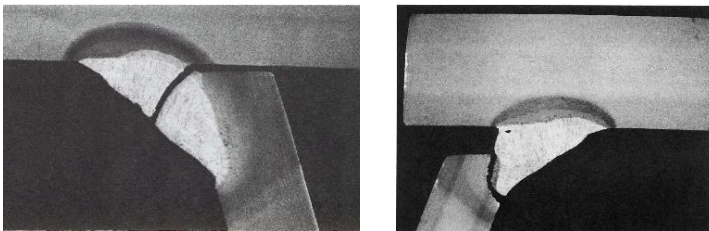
Biegebeanspruchte Schweißnähte orthotroper Platten nach Maddox [107] und deren Versagensformen
